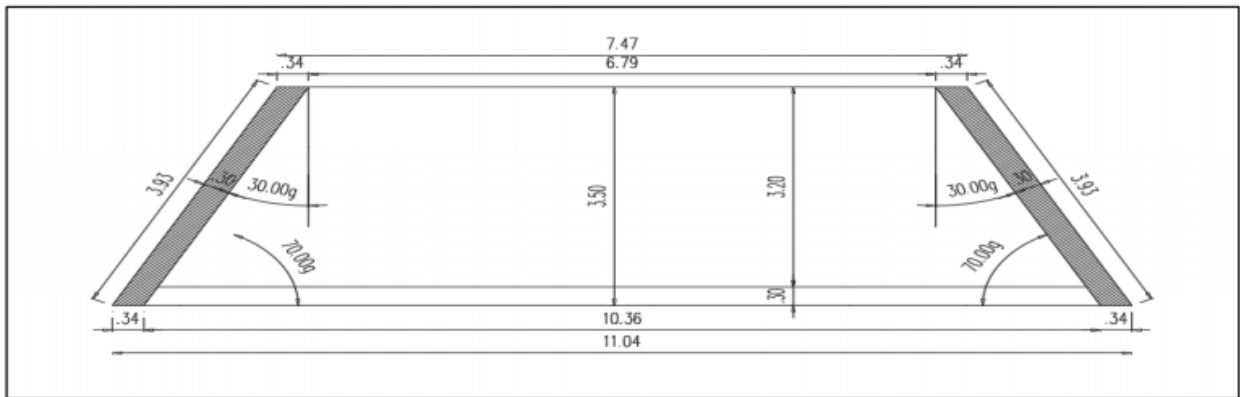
VUE EN PLAN ET COUPE MUR DE TETE
